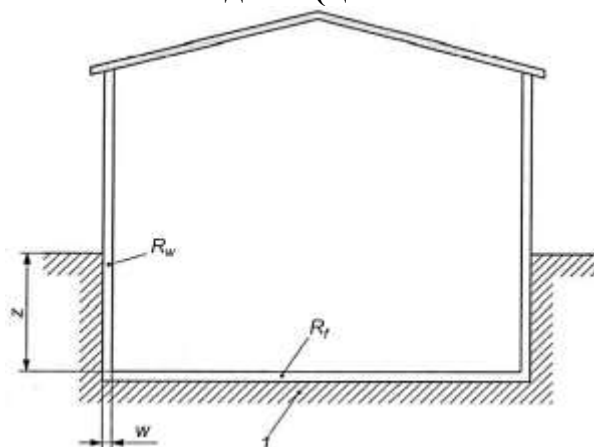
Будівля з опалюваним підвалом (цокольним поверхом)
